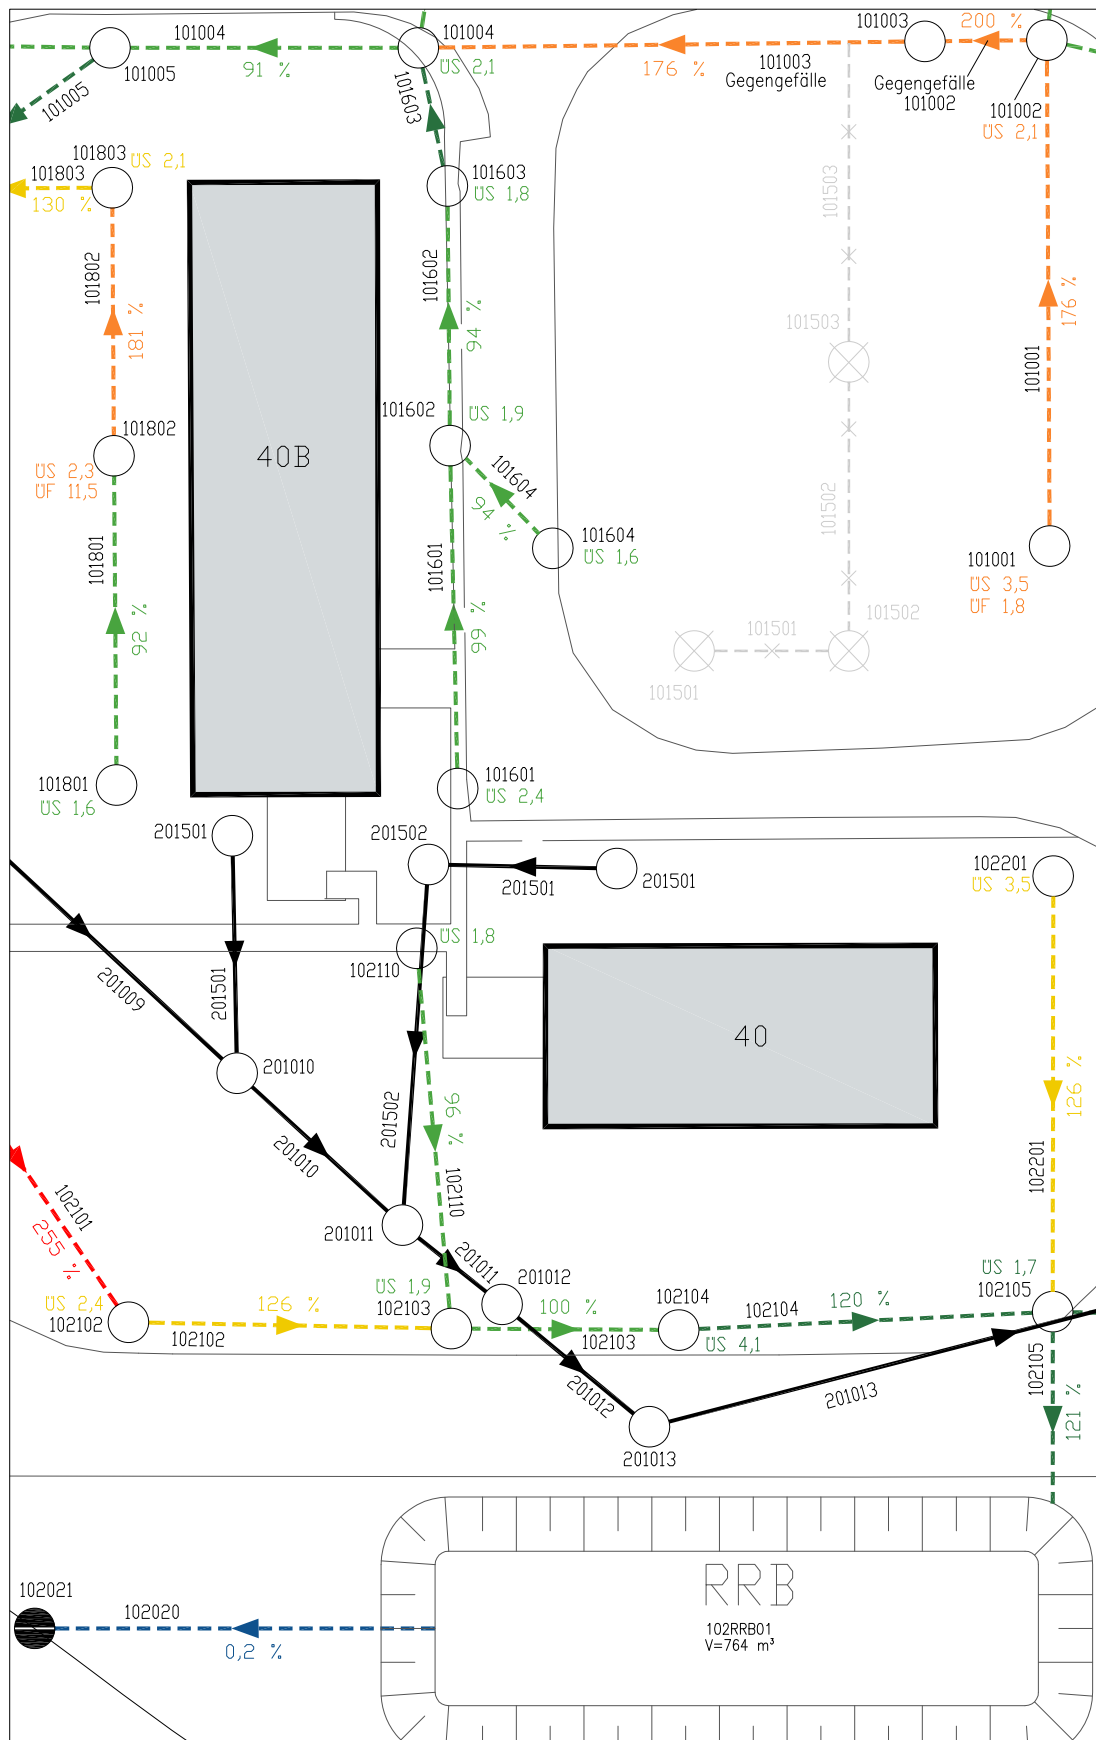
11 Beispielplan: Lageplan „Hydraulische Auslastung“
